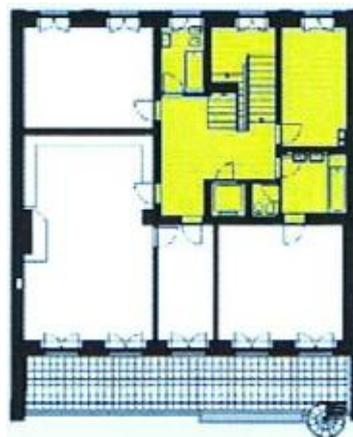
Núcleo de betão armado (a amarelo) realizado na intervenção 1950.
